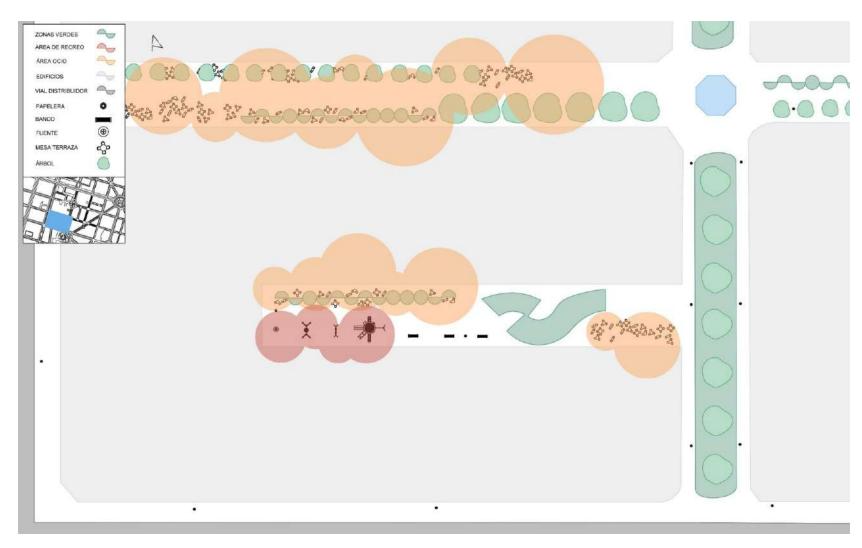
Plano de detalle 5. Escala 1:500 (A3).
